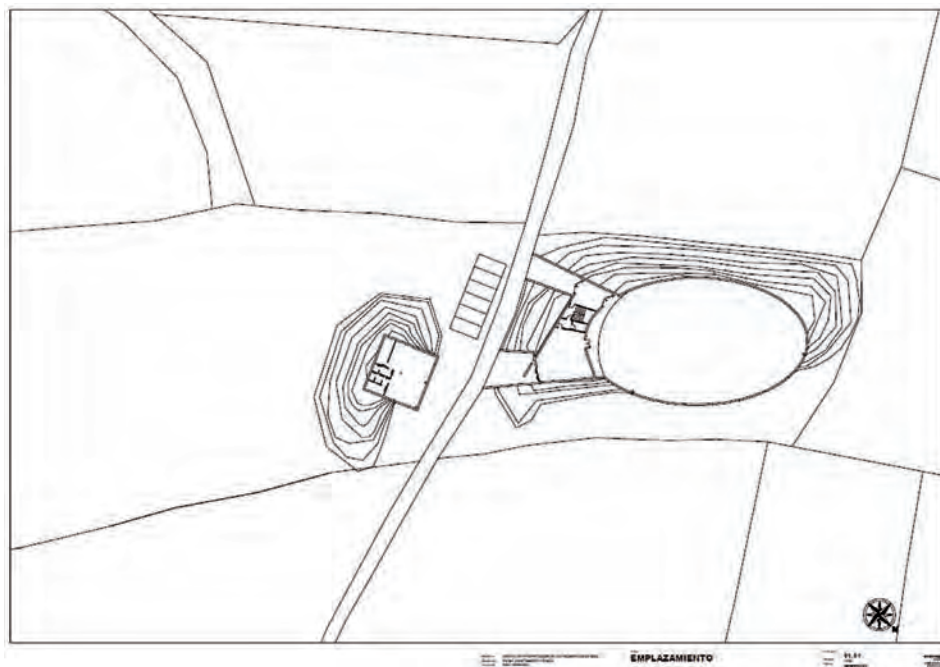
Plano de emplazamiento del Ciyab. Carlos Malagón.
